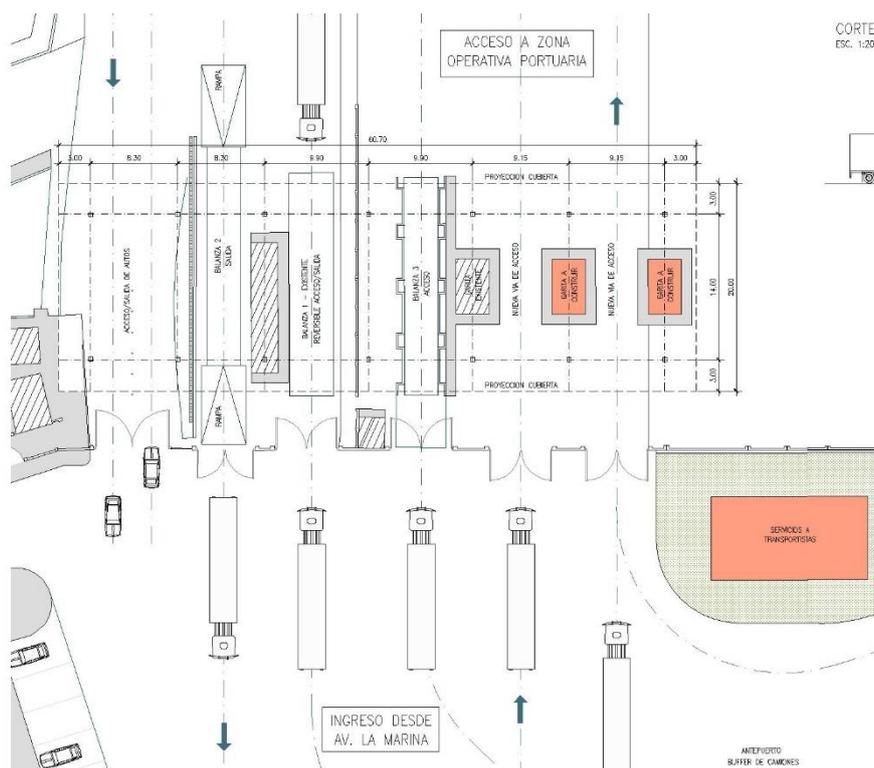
Vista en planta preliminar de gate de acceso al TPMS
